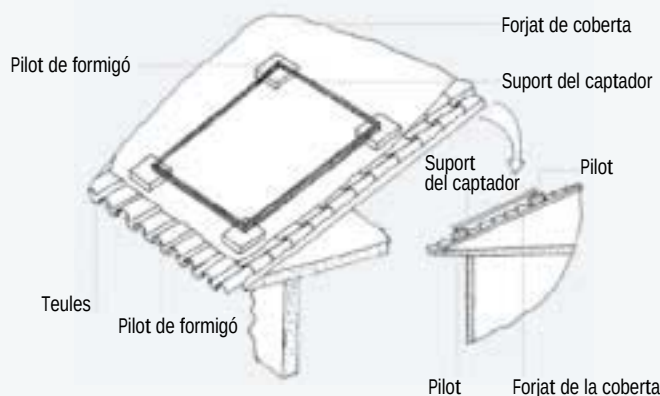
Estructura suport amb ancoratges de formigó sobre superfície inclinada.
